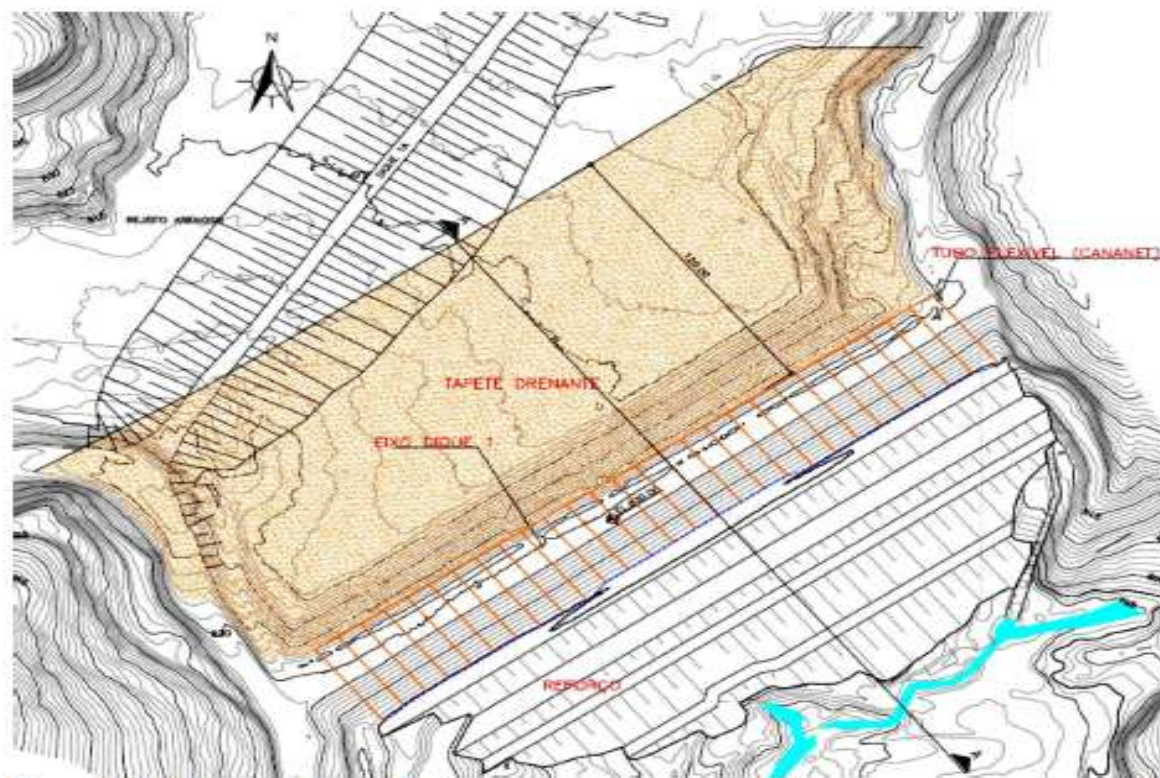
Imagem ilustrativa de uma planta de implantação do tapete drenante na elevação 826m.
